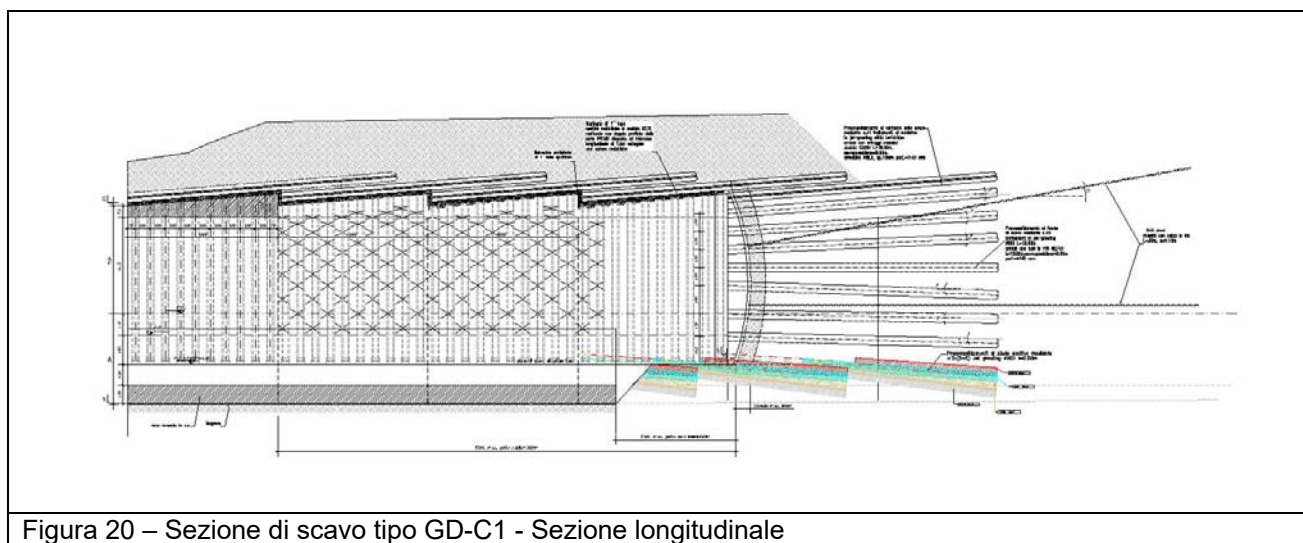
Sezione di scavo tipo GD-C1 - Sezione longitudinale
